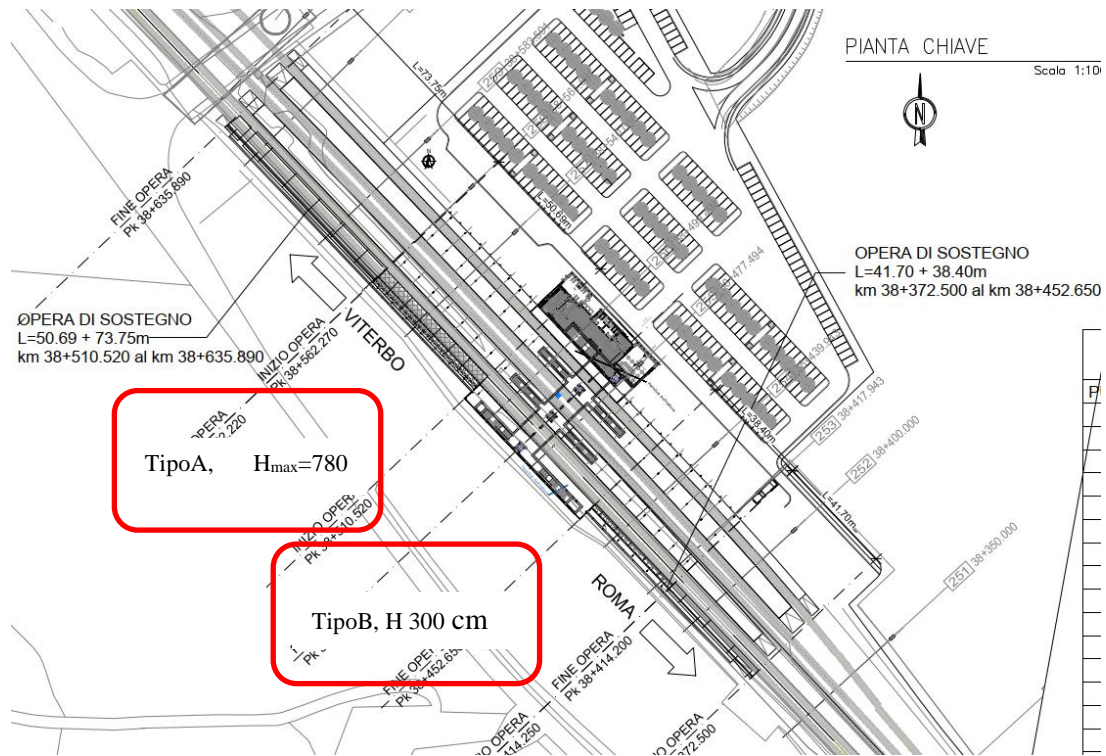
Planimetria muro di sostegno sul lato opposto di parcheggio
